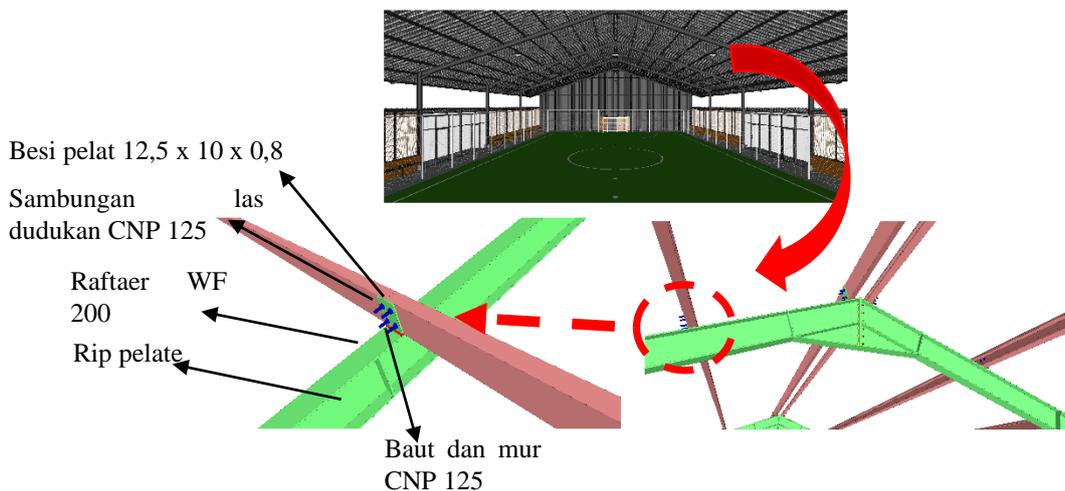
Struktur tengah profil baja IWF gelanggang olahraga lapangan futsal.
